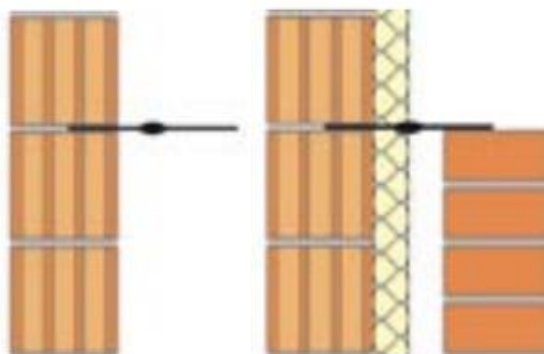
Posicionamento dos grampos em alvenaria de tijolo face à vista
